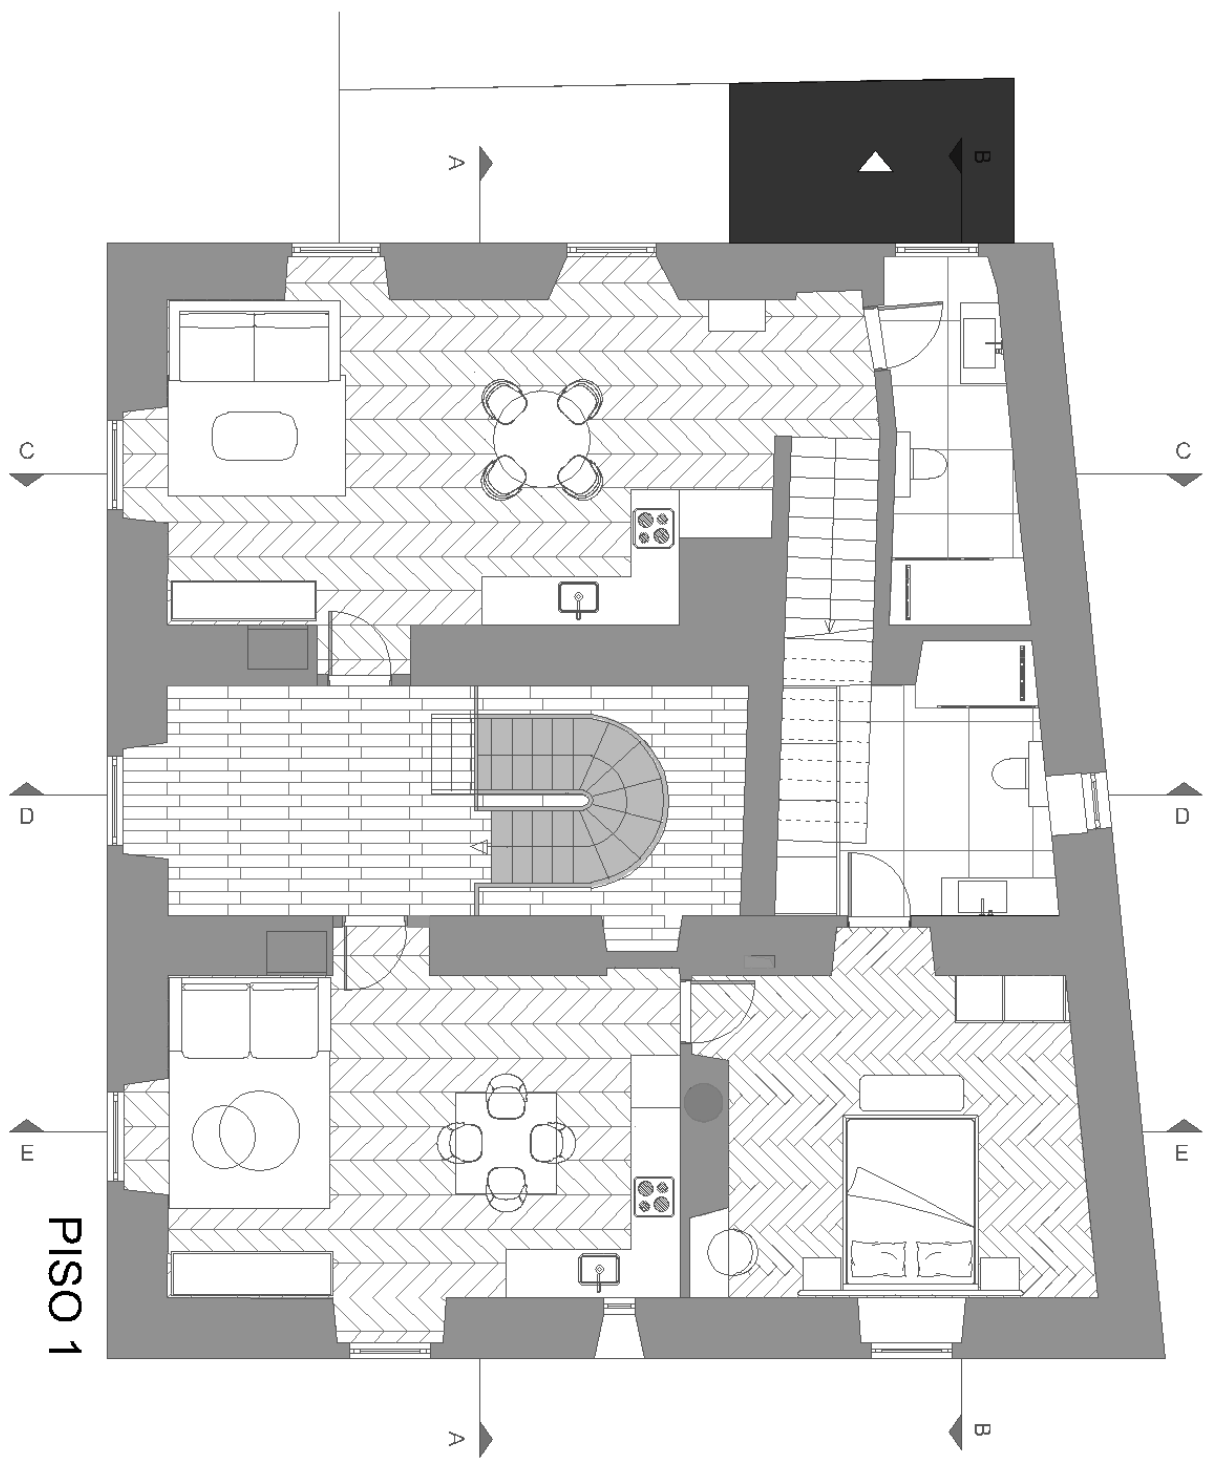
Planta do piso 1 com identificação dos cortes (Não está escala)
